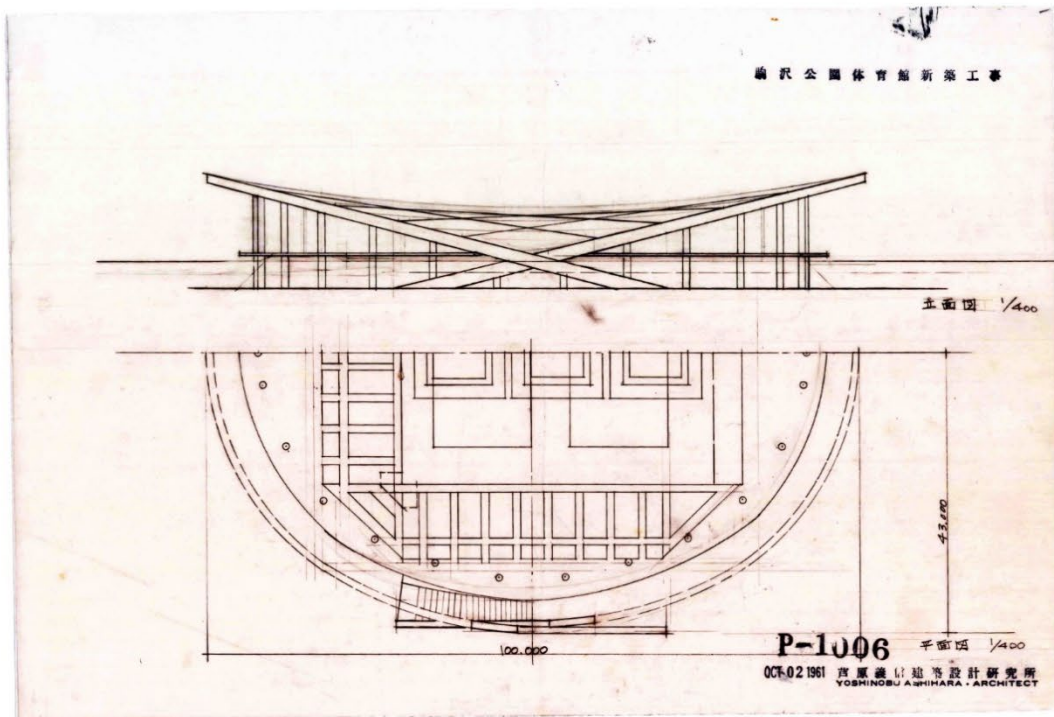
P-1006 HP シェル楕円形立面図、平面図
